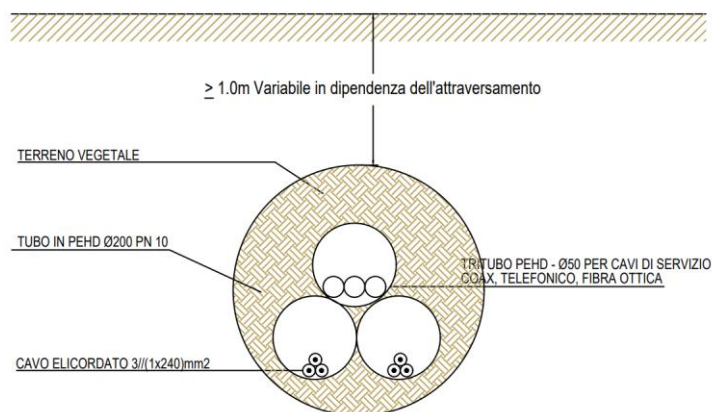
Sezione tipo T.O.C. – Attraversamento con sonda teleguidata
